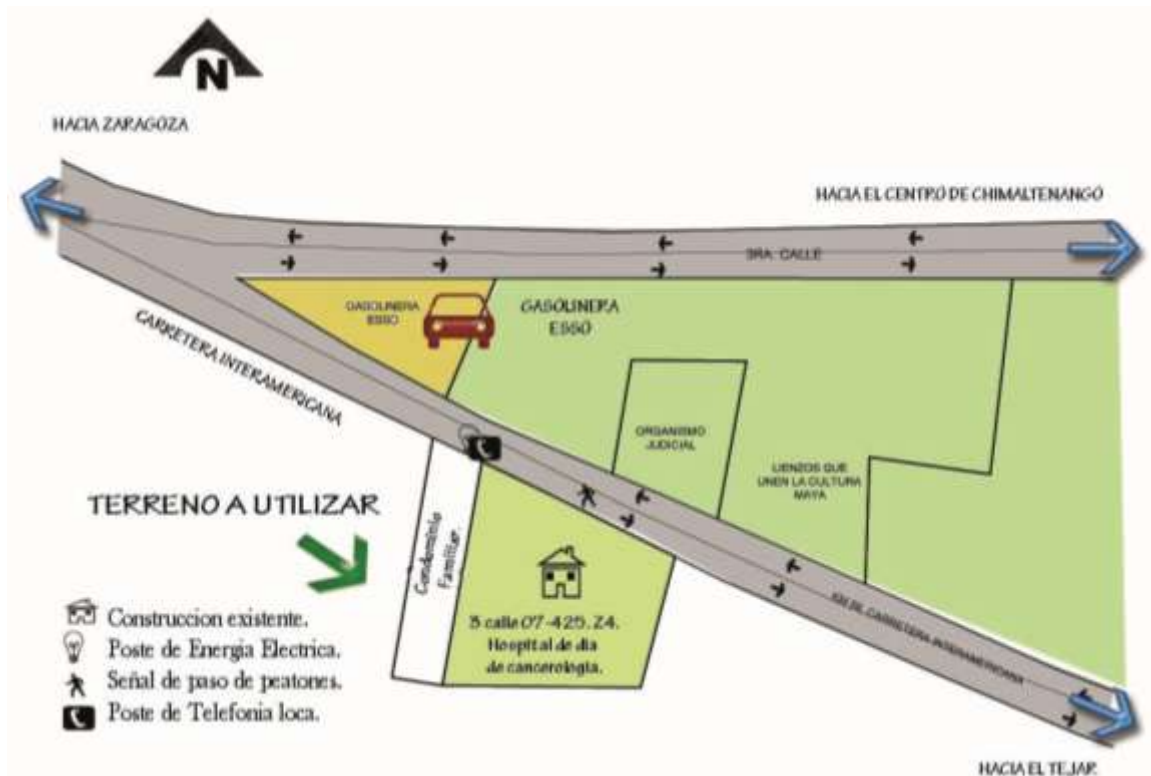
PLANO DE LOCALIZACIÓN DEL TERRENO A INTERVENIR.
